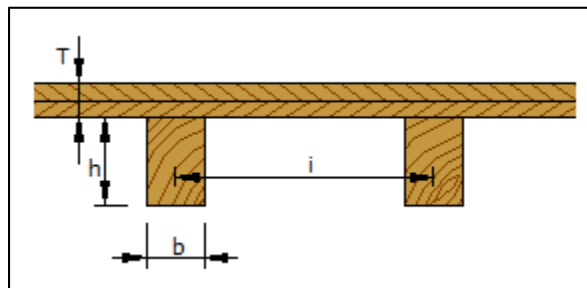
Détail du plancher adaptée pour la modélisation sur 3Muri©
